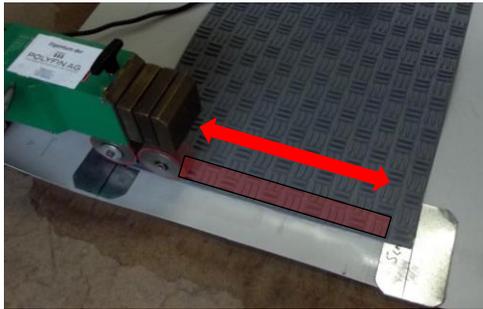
Zuerst die Quernähte der Platten mit dem Automaten schweißen. Durch die zwischengelegten Bleche verbleibt eine unverschweißte Zone an den Längskanten.
